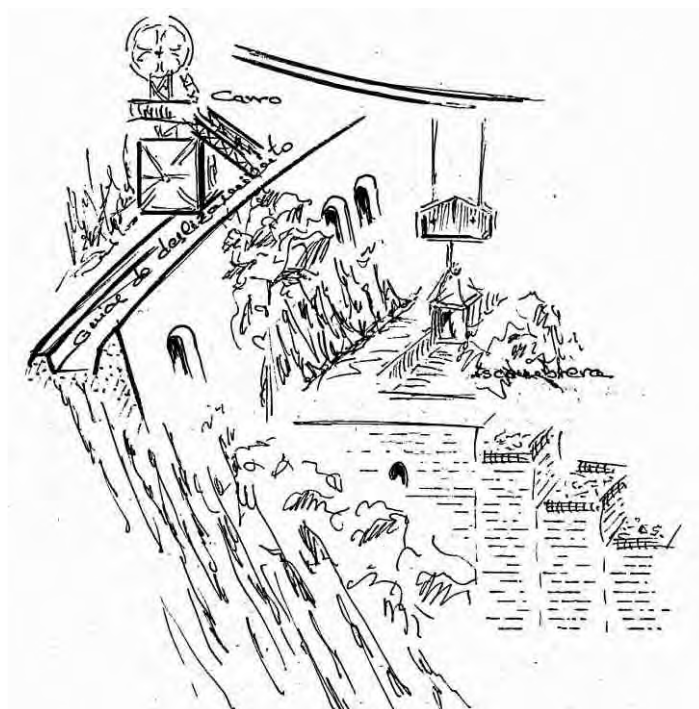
Dibujo en plumilla del grúa cable. Autores.
